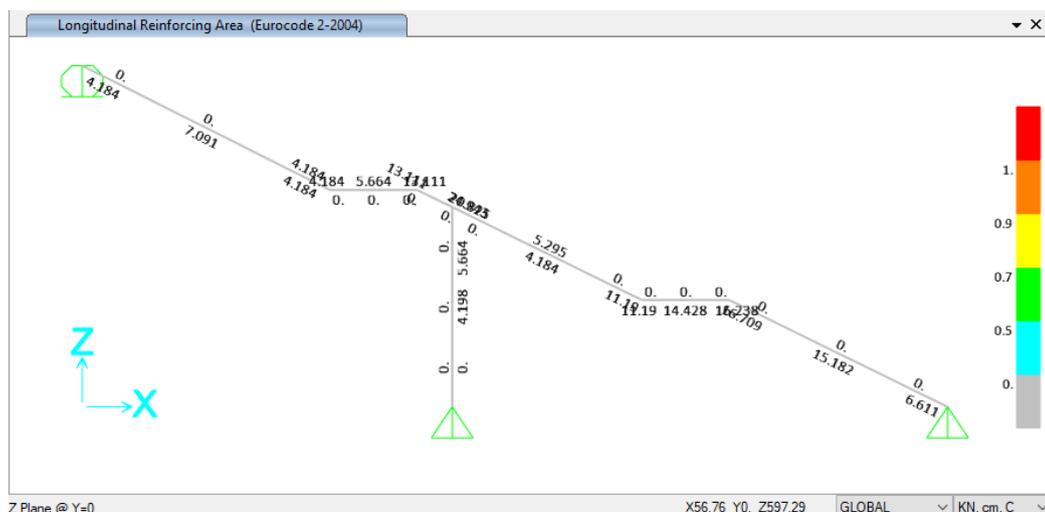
Rinforzo longitudinale – Scala tipo 3 (cm<sup>2</sup>/m)
